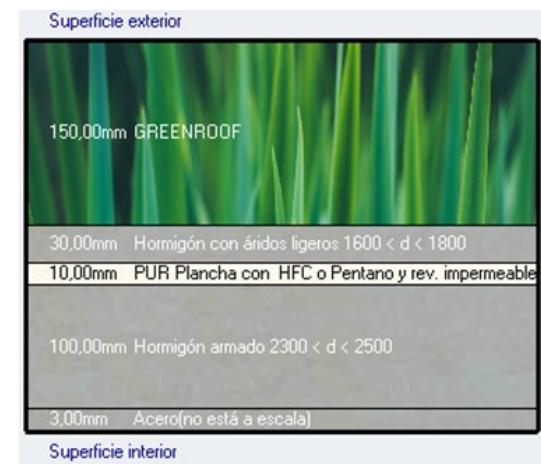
Cubierta en estudio. Tipo GR-Cp-R2-b. Fuente: Design Builder
